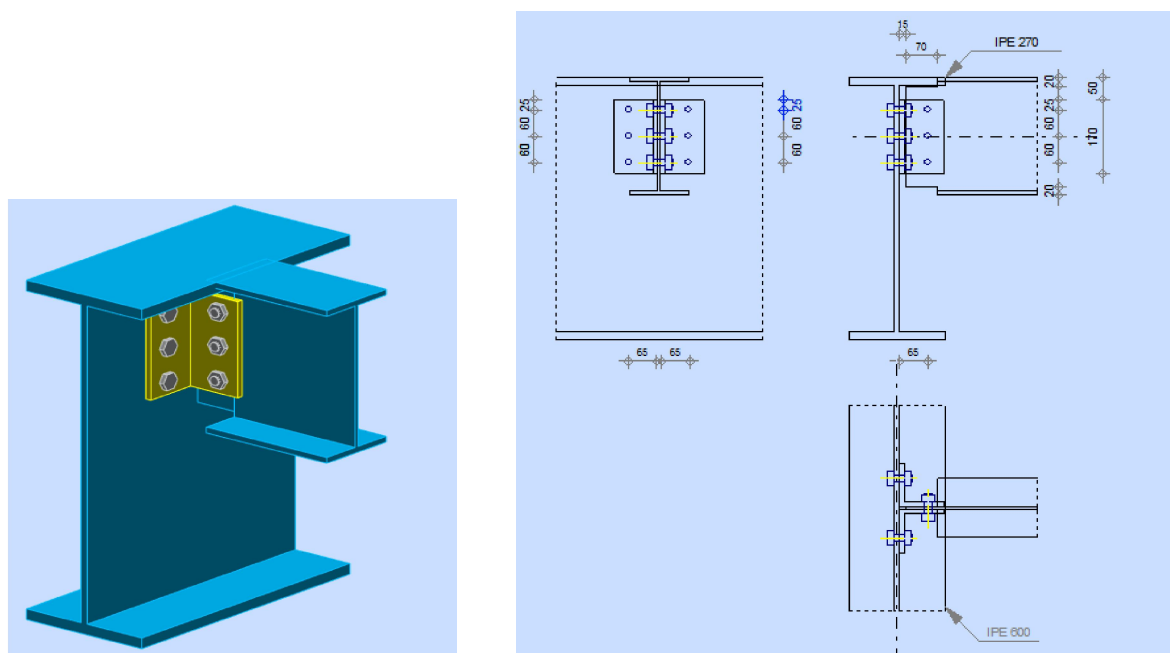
Assemblage poutre principale IPE600 et solive IPE270
